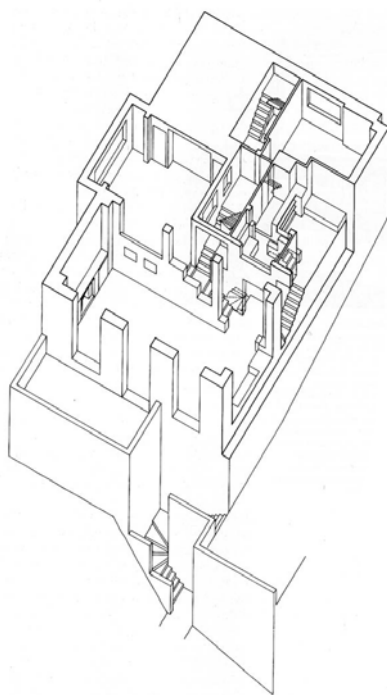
A. Loos, Casa Müller, sezione assonometrica del Raumplan
